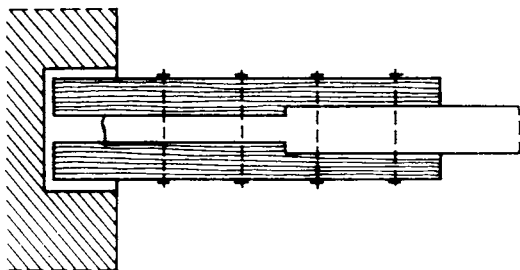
Новая верхняя часть балочного перекрытия из накладок
